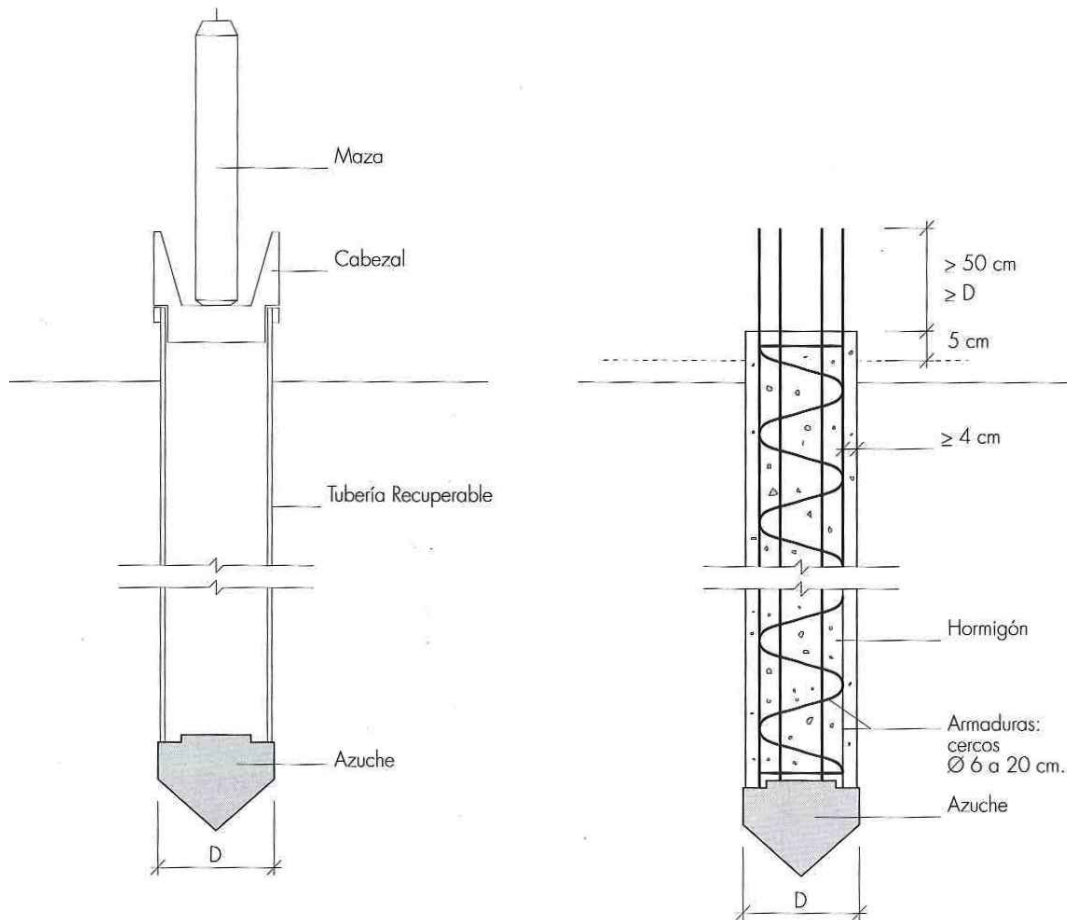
Pilote "in situ" con desplazamiento, con azuche
